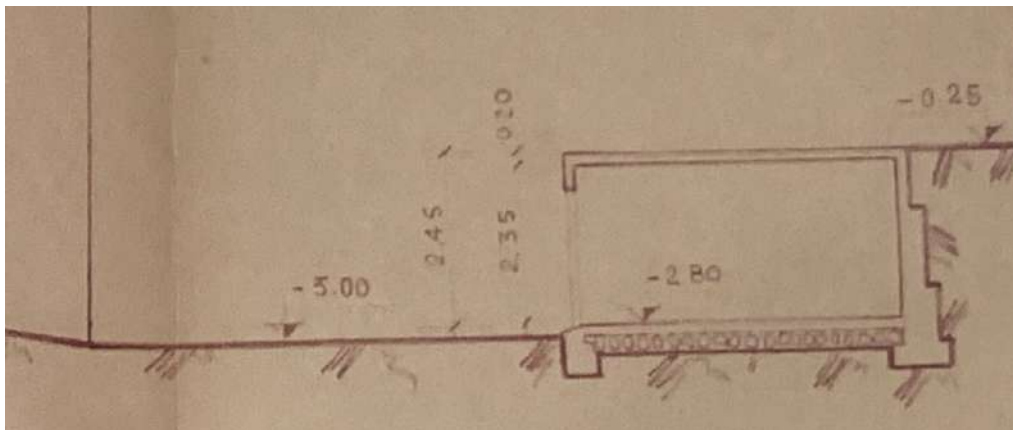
Estratto Di. N.1215 allegato alla Licenza edilizia n. 39010=7739 del 08.02.1958 – sezione
